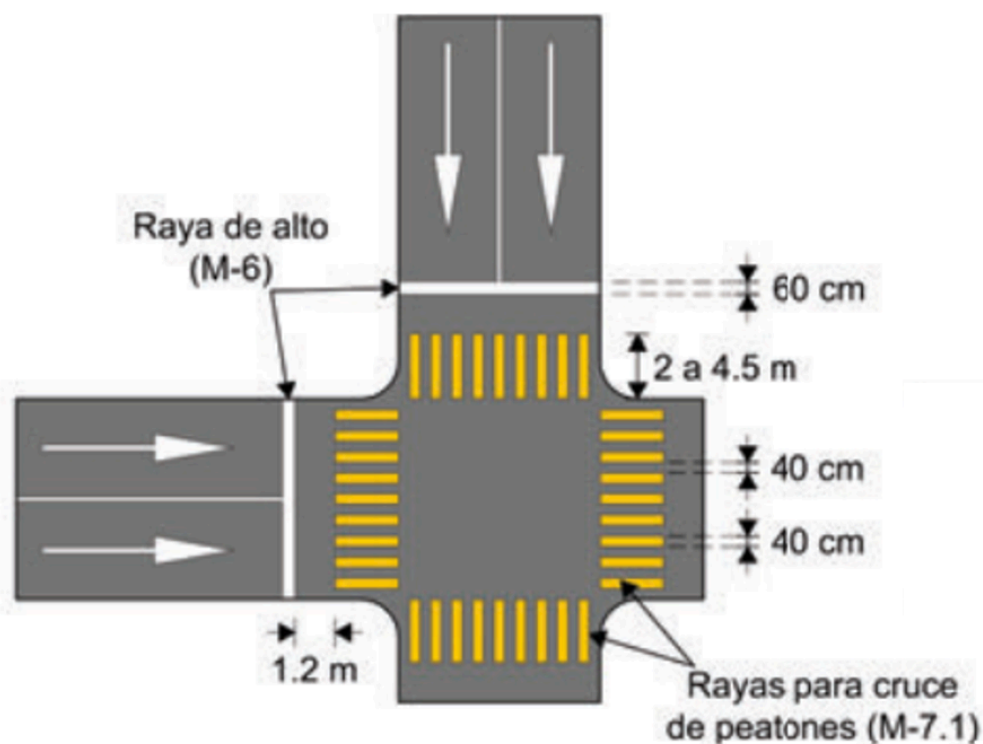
Marcas en el pavimento de carreteras con ancho de arroyo vial de hasta 6.5m.
